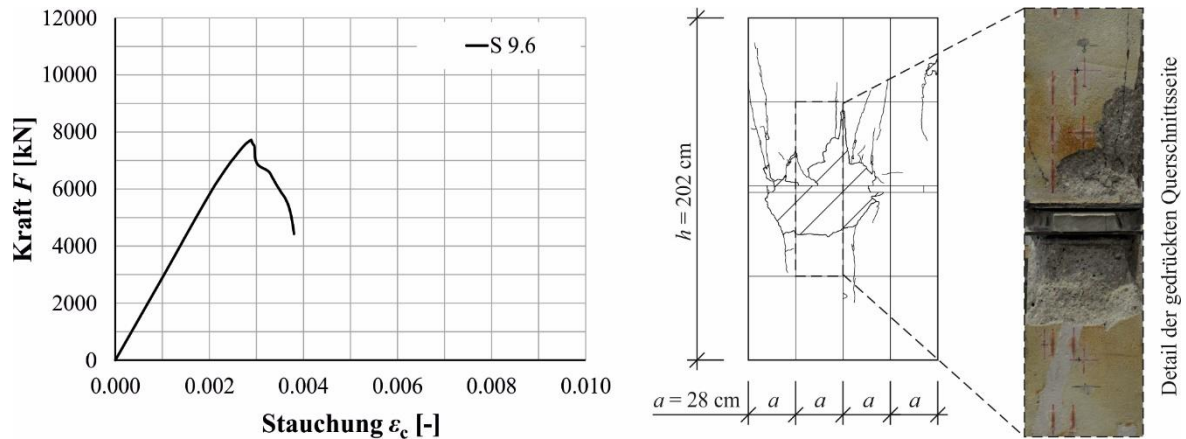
Kraft-Stauchungs-Beziehung (links) und Bauteilversuch S 9.6 nach Versagen (rechts)
